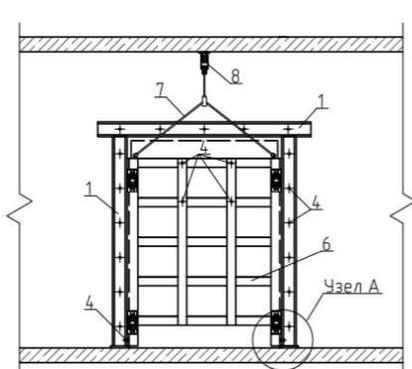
Вид спереди при вертикальном резе проема несущей железобетонной или каменной стены
